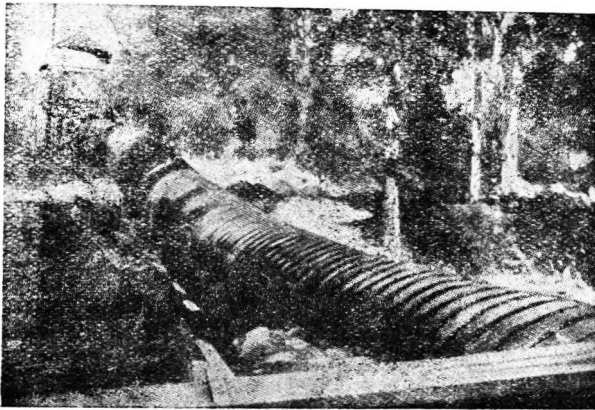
Зльверум. Железобетонный напорный трубопровод.
